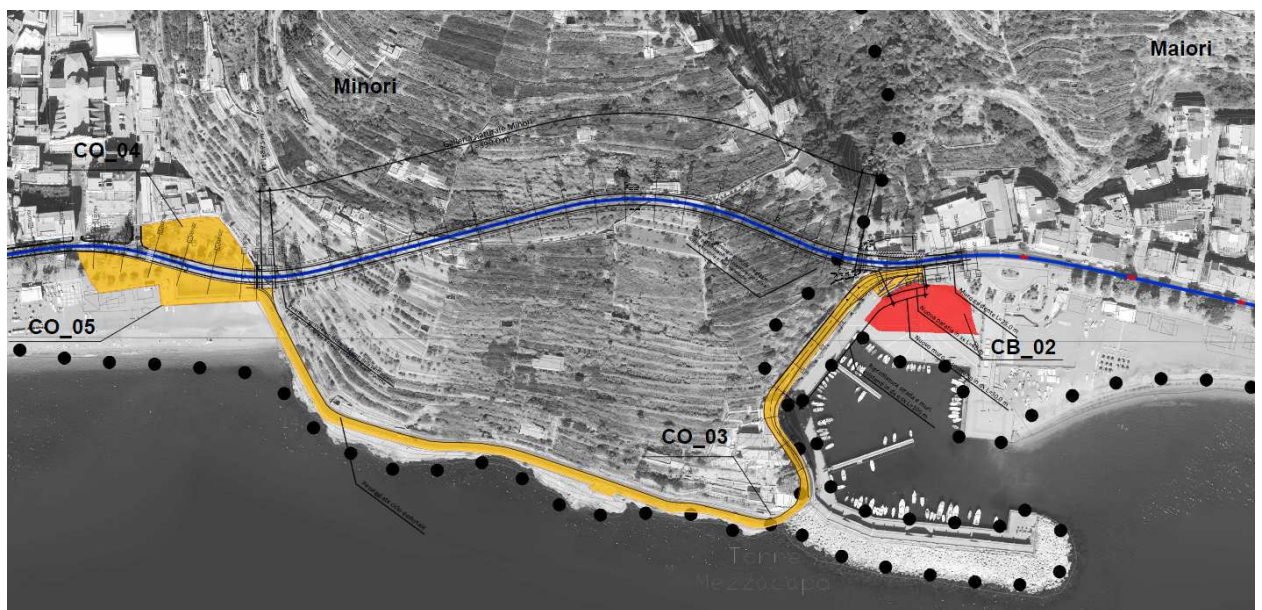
Localizzazione aree di cantiere, fase 2, Stralcio tavola "Planimetria aree di cantiere e viabilità" (T00IA04CANPL01A)
